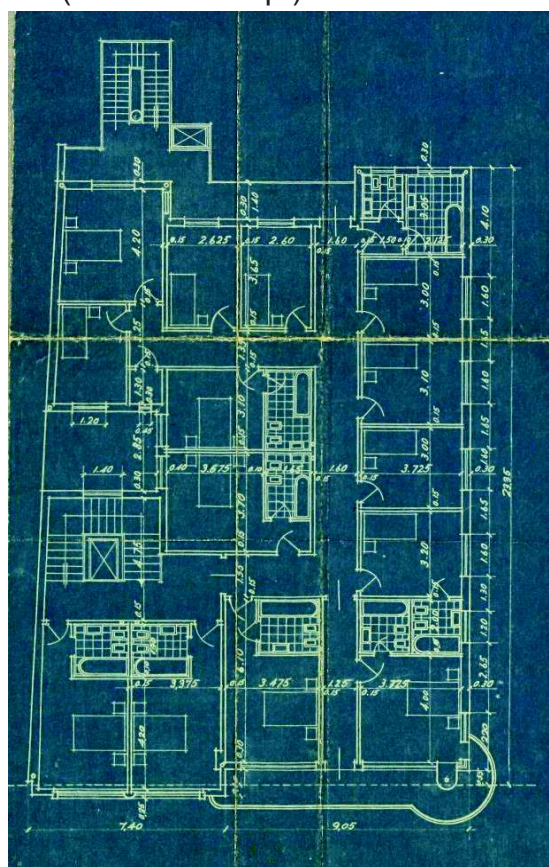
Planta Piso 1 Fonte Arquivo municipal de Lisboa
